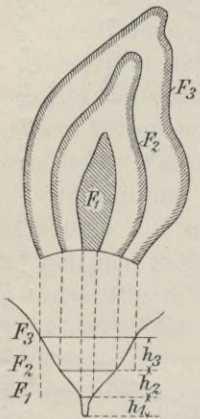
Berechnung des Stauinhaltes eines Talbeckens.
